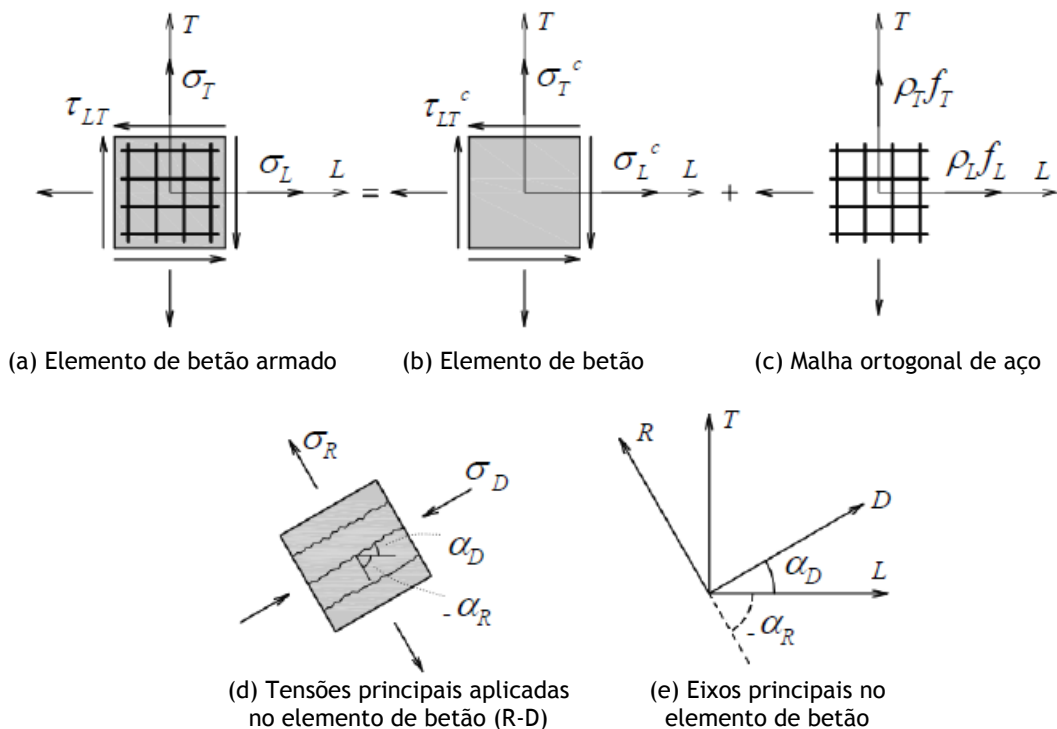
Elemento bidimensional de betão armado submetido a tensões de membrana (adaptado de Silva em 2016 [43]).
